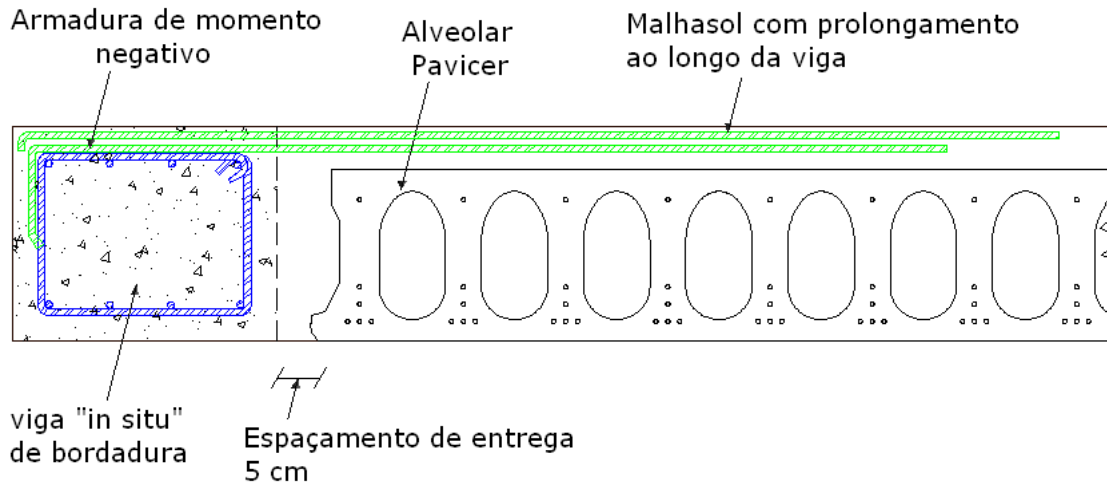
Pormenor tipo de apoio em viga de bordadura.
